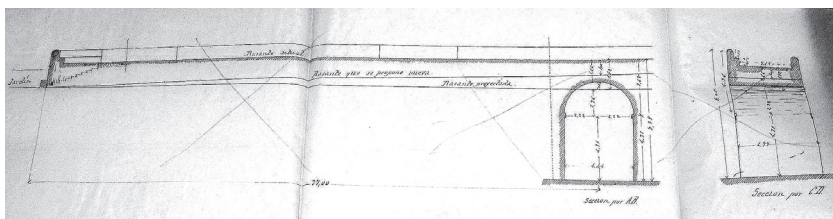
Alzado y sección de la muralla Sur con la marca de la rasante que se quiere dar al rebajar la altura del lienzo. ADL, leg. 18.829, 18-VII- 1907.
